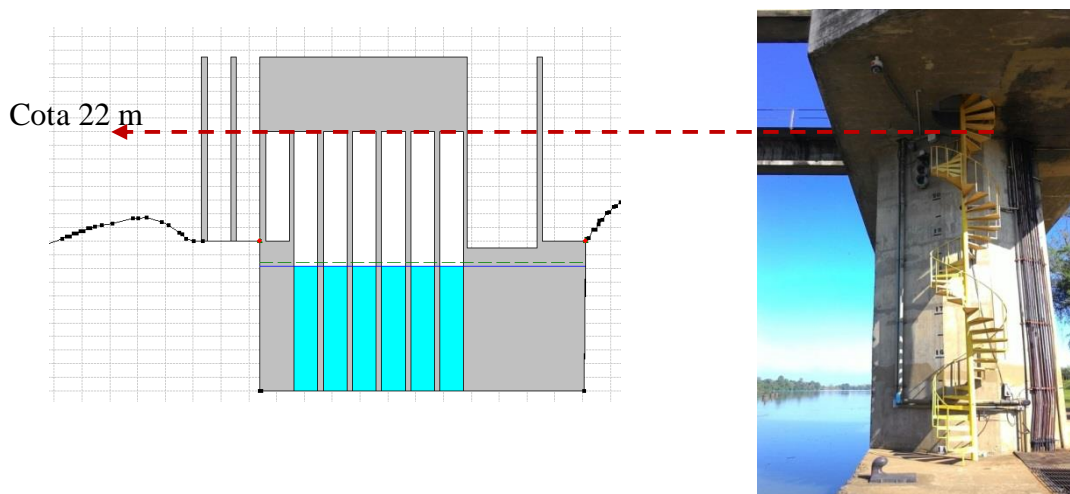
LOCALIZAÇÃO E DETALHE DA BARRAGEM DE BOM RETIRO.
